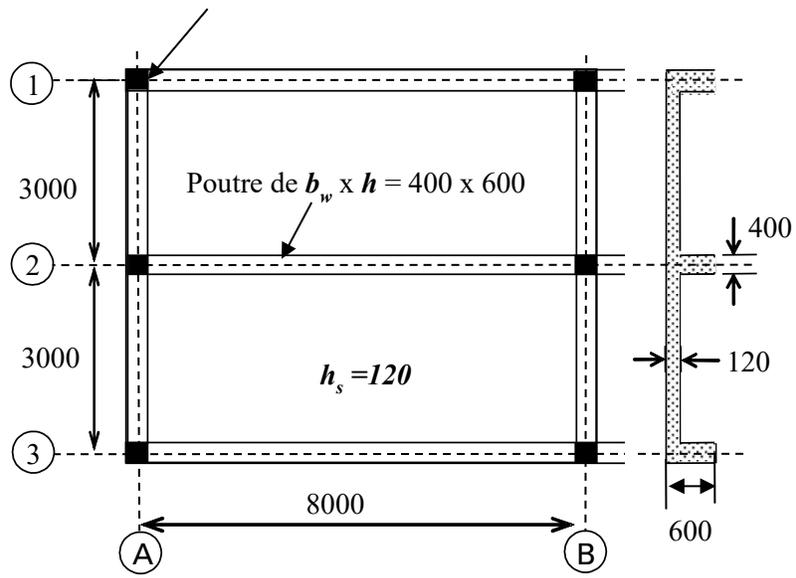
Vue en plan et coupe du plancher (pas à l'échelle)
